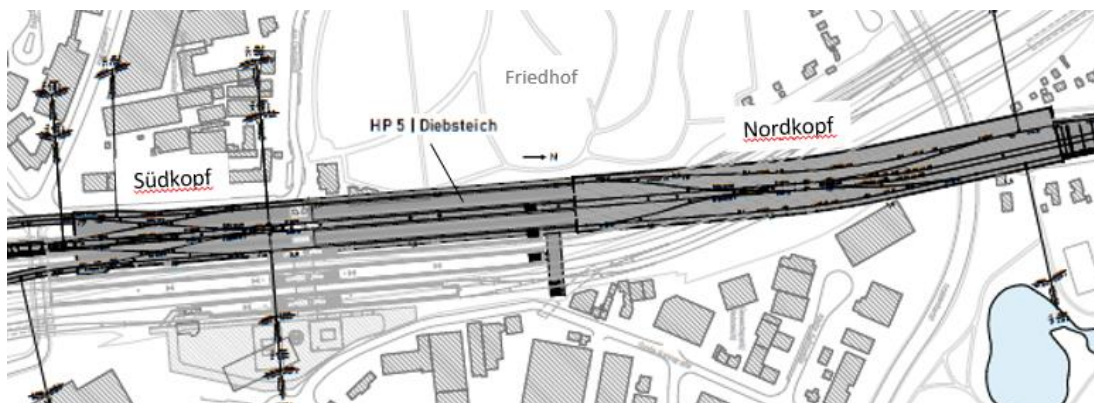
HP Altona Diebsteich Var. 1c – Lageplan
